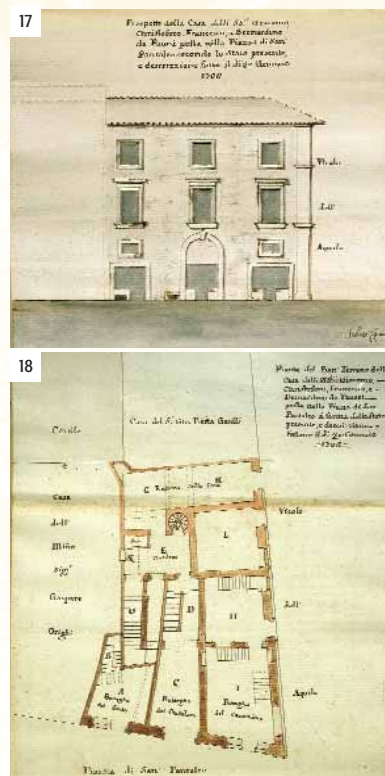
e 18 - 1702, Sebastiano Cipriani, Prospetto e pianta della casa dei Fratelli Pavesi in piazza S. Pantaleo angolo vicolo dell'Aquila, ASR, TNC, uff. 5, vol. 367, cc. 817bis, 817ter
